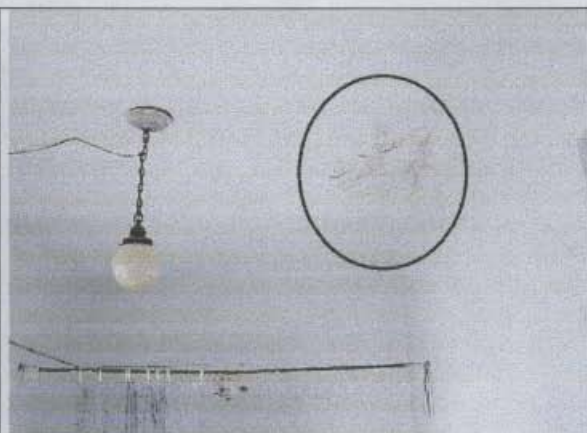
Vista interna del baño ubicado en segundo piso, sin daños estructurales que evidencien mal comportamiento, solamente hay desprendimiento de acabados.
